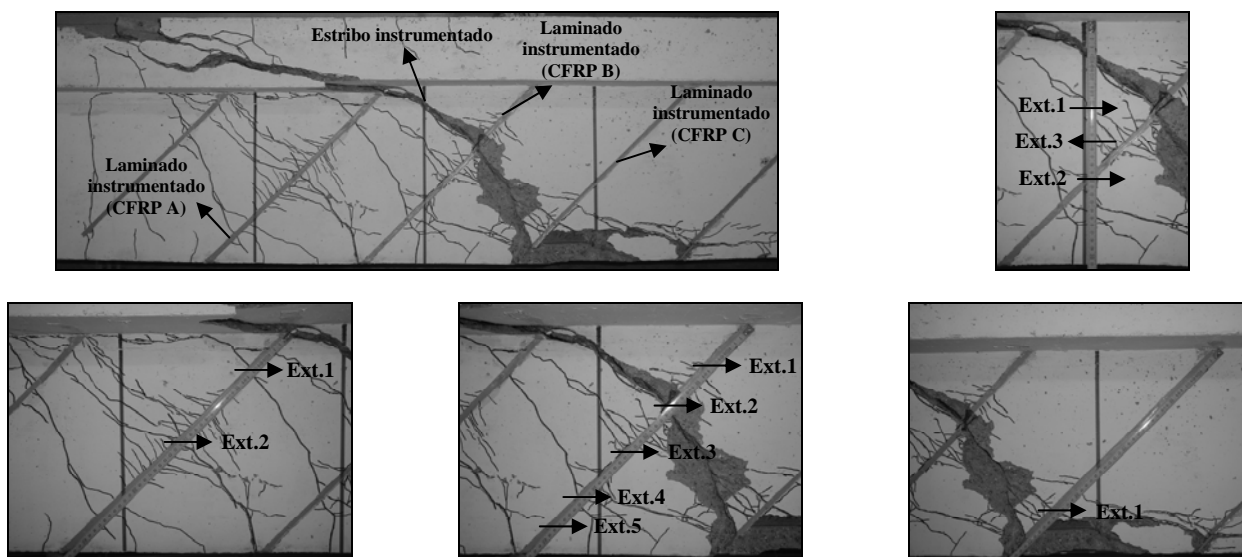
Localização dos extensômetros no laminado e estribo instrumentados da viga 3S-5LI45F2-D.
